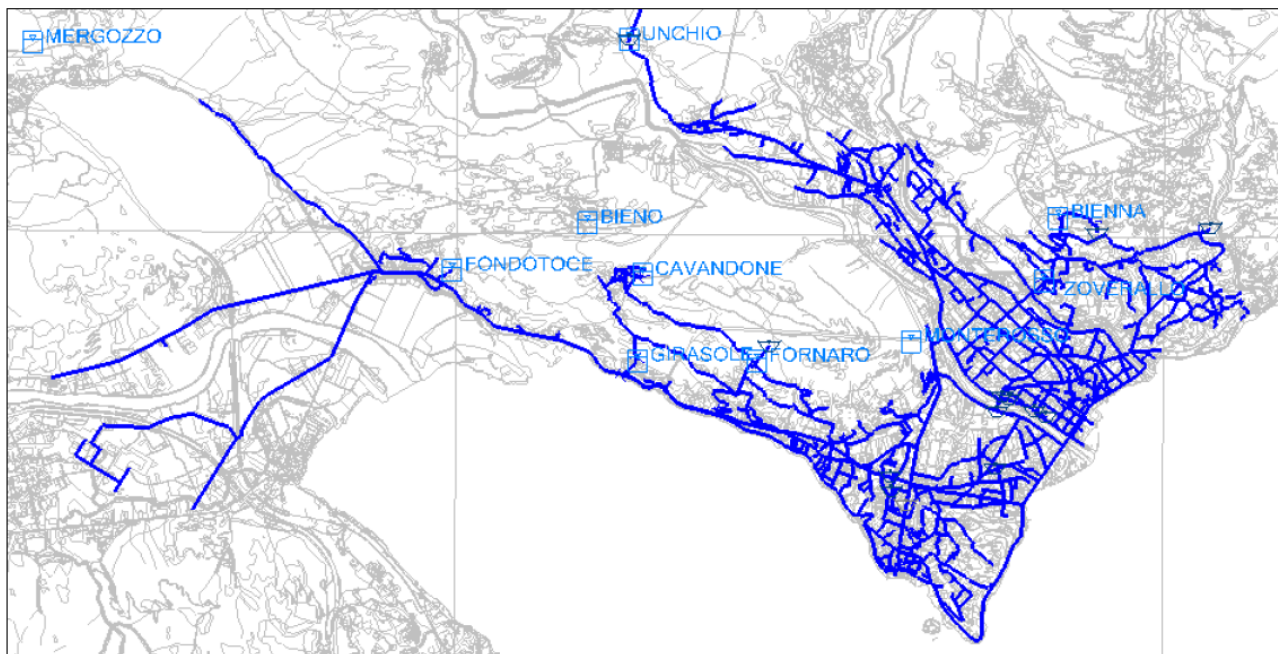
schema planimetrico della rete di distribuzione di Verbania
